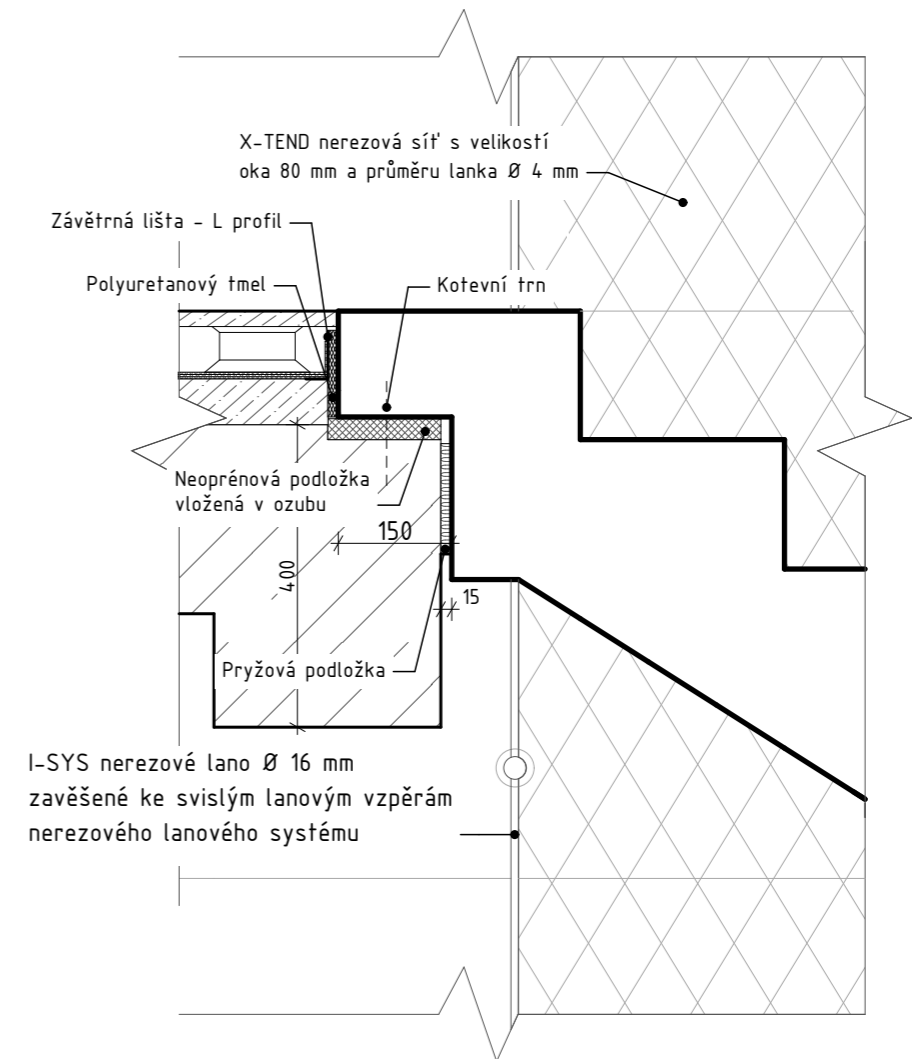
DETAIL E: KOTVENÍ FASÁDNÍHO SYTÉMU - PŮDORYS
